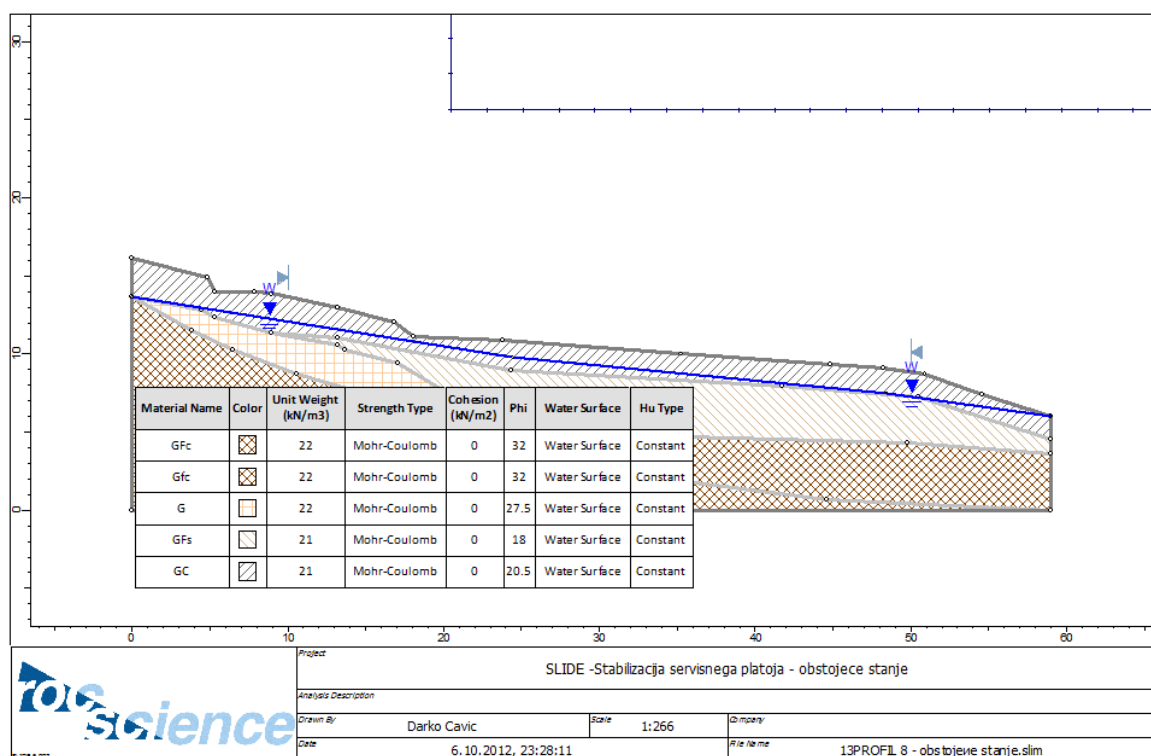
Stabilizacija servisnega platoja – obstoječe stanje – PROFIL 6
